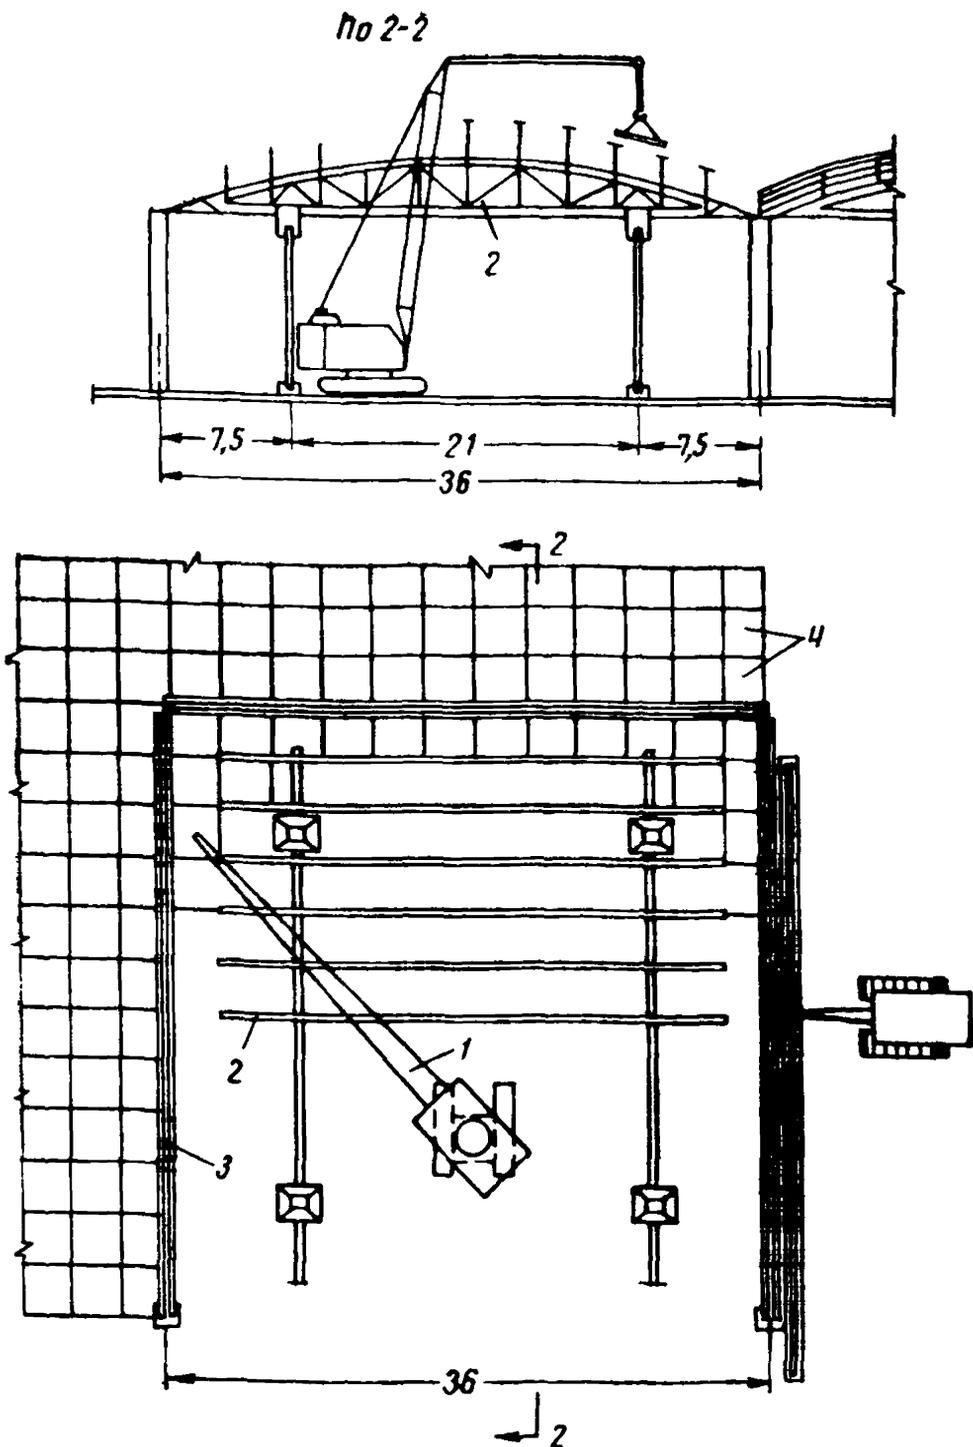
б. Монтаж плит размерами 3×3 м оболочек двойкой положительной кривизны на инвентарном стальном кондукторе из сегментных ферм
